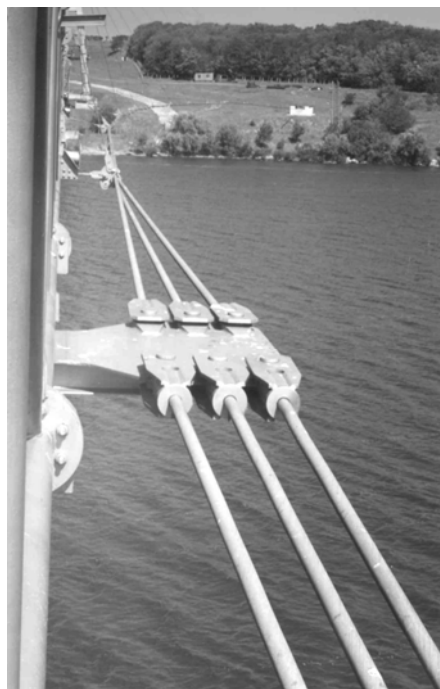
Пояс ветровой фермы и средний узел крепления пояса к балке жесткости
